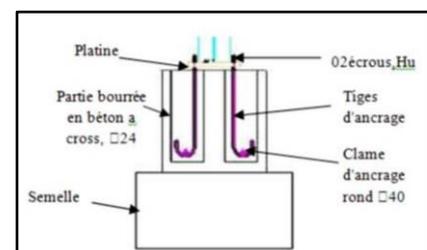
Détail n°01, Articulation pied de poteau – fondation Source : Les auteurs.
